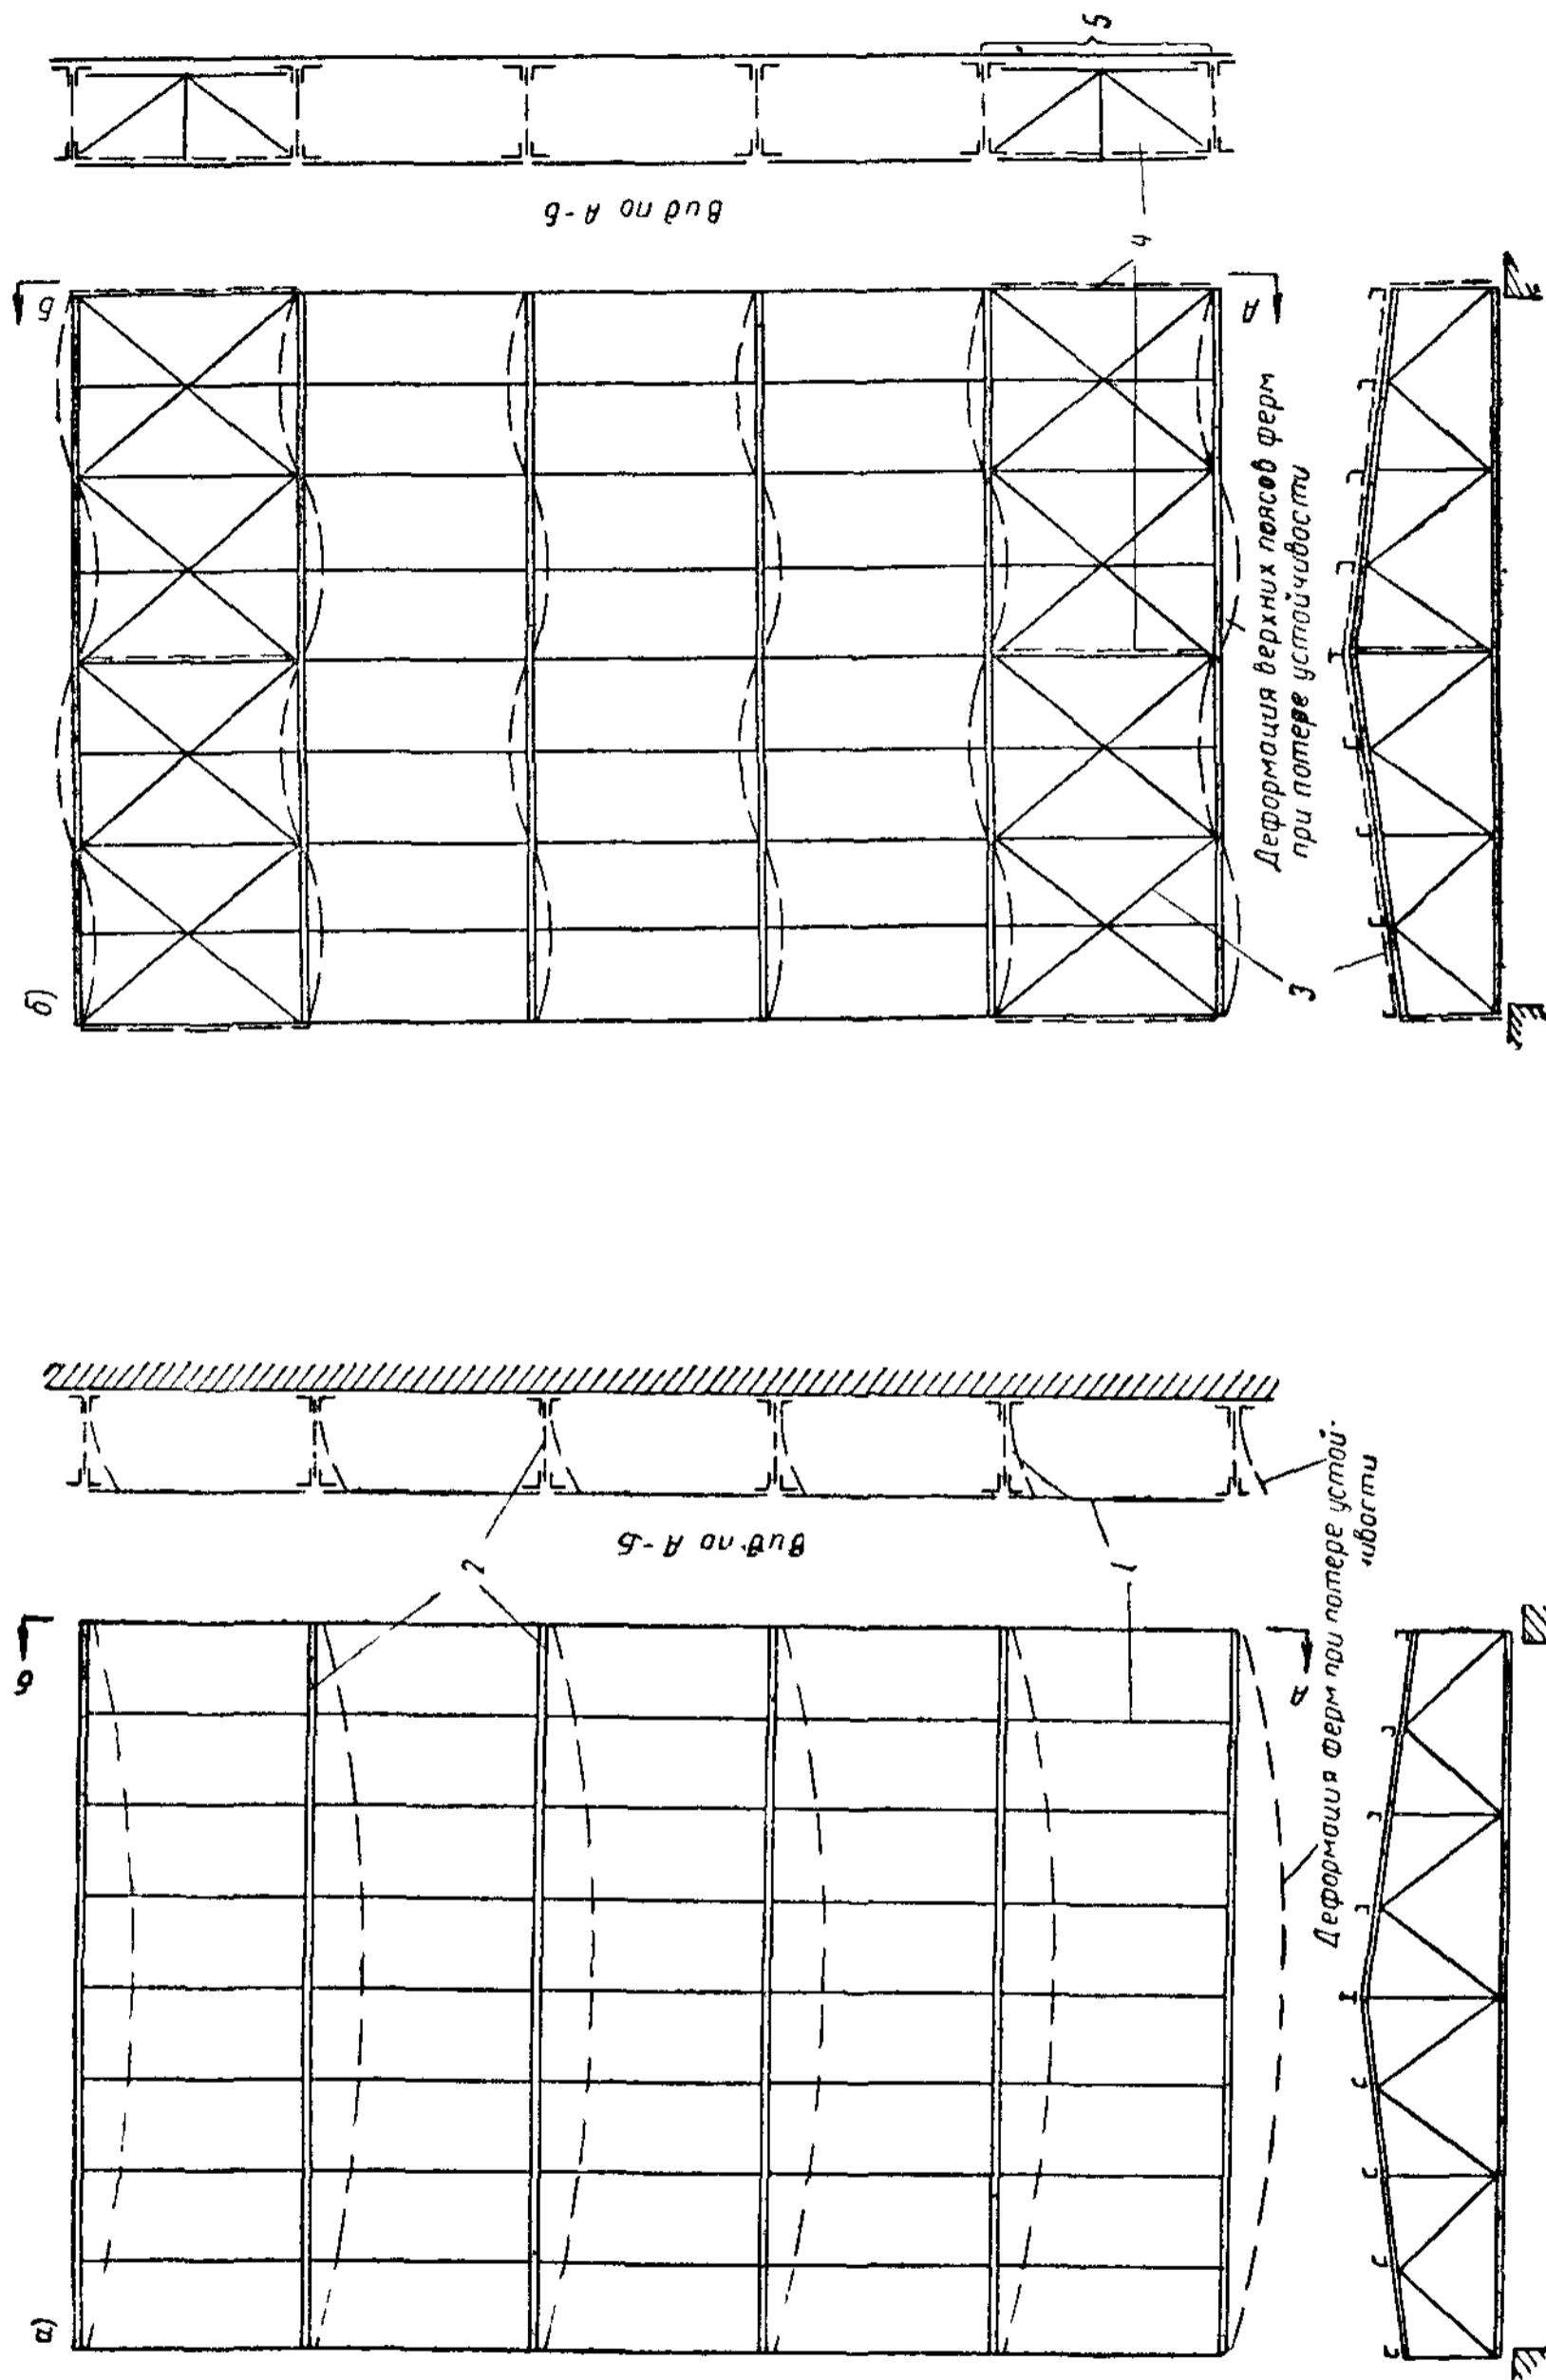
Мероприятия, обеспечивающие устойчивость стропильных ферм
